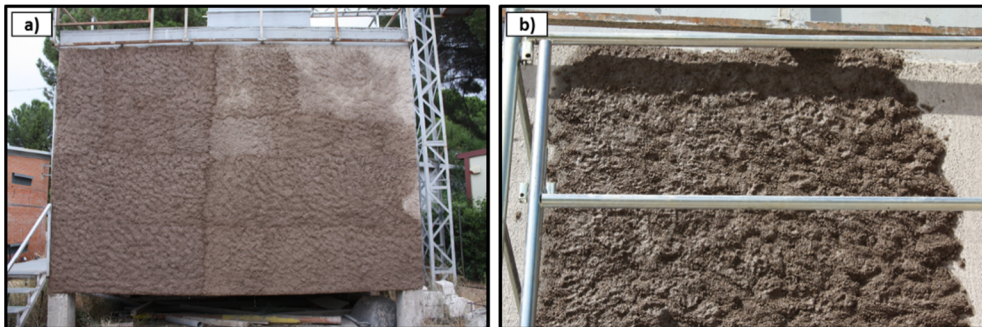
(a) Aplicación de la primera capa de mortero. (b) Enfoscado de la fachada
